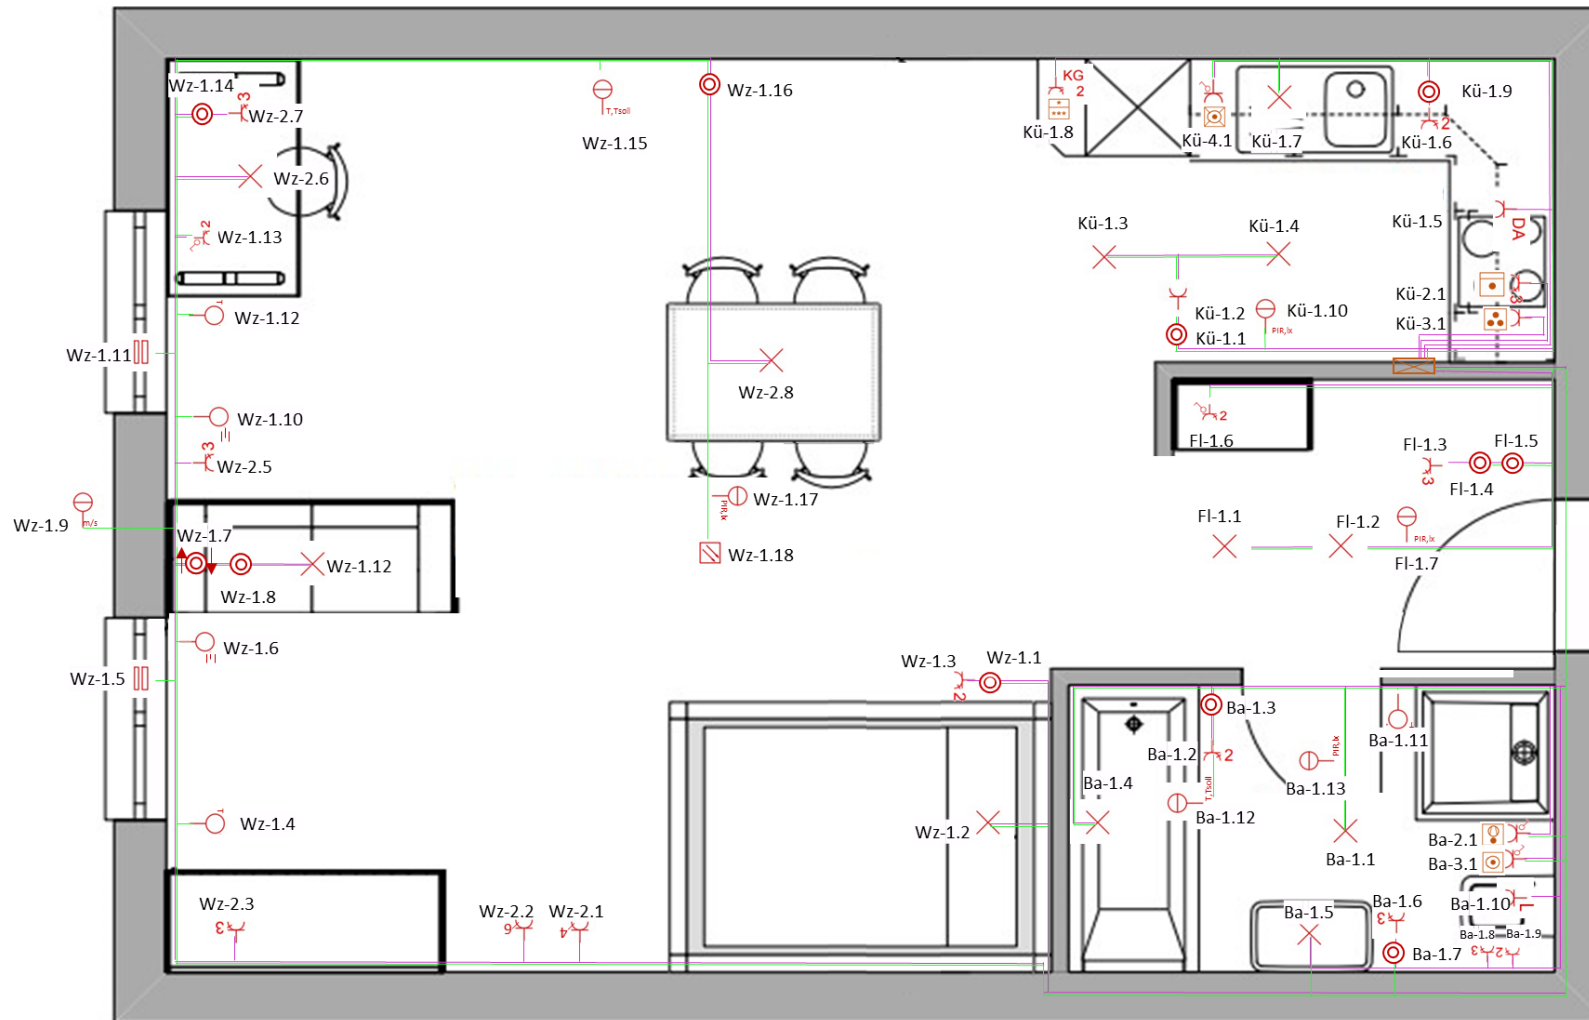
Grundrissplanung, Einzimmerwohnung- KNX Technologie- Vollausrüstung
